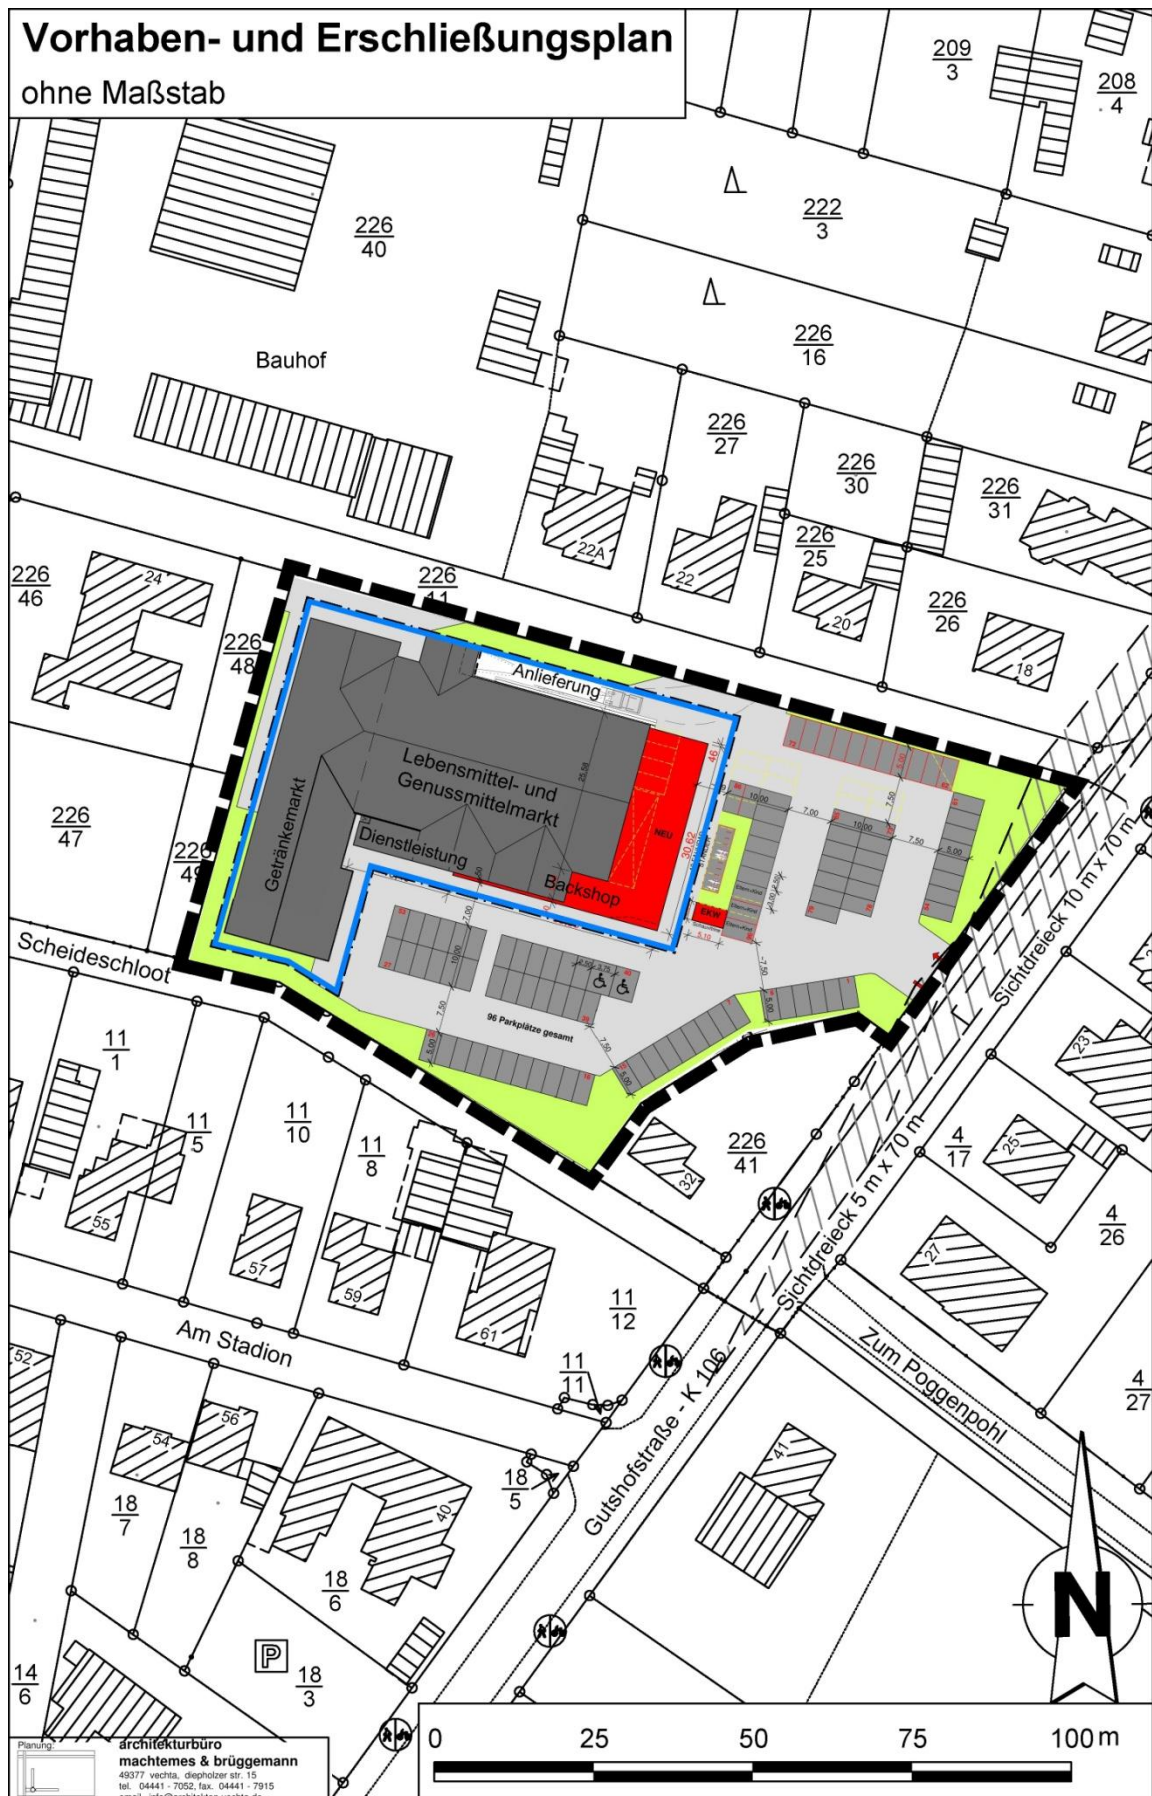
Vorhaben und Erschließungsplan (V+E - Plan)
